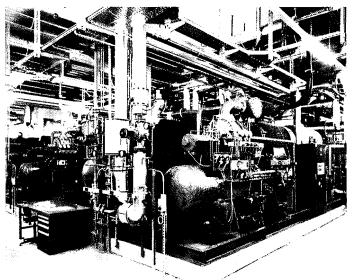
Das Herz des Energieverbundsystemes sind die Wärmepumpen/Kältemaschinen. Sie werden doppelt genutzt, um «Wärme und Kälte zu produzieren».
